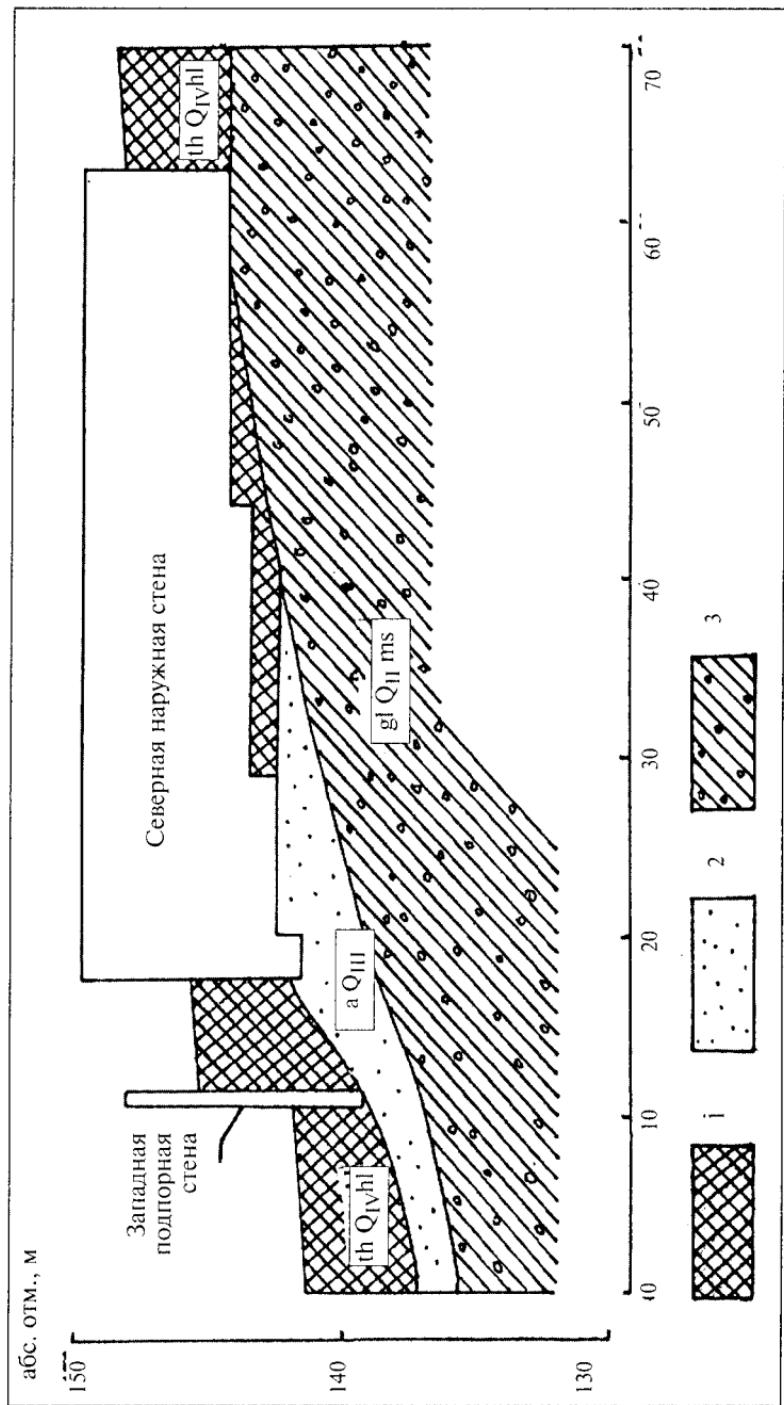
Геологический разрез по северной наружной стене здания МАРХИ:
